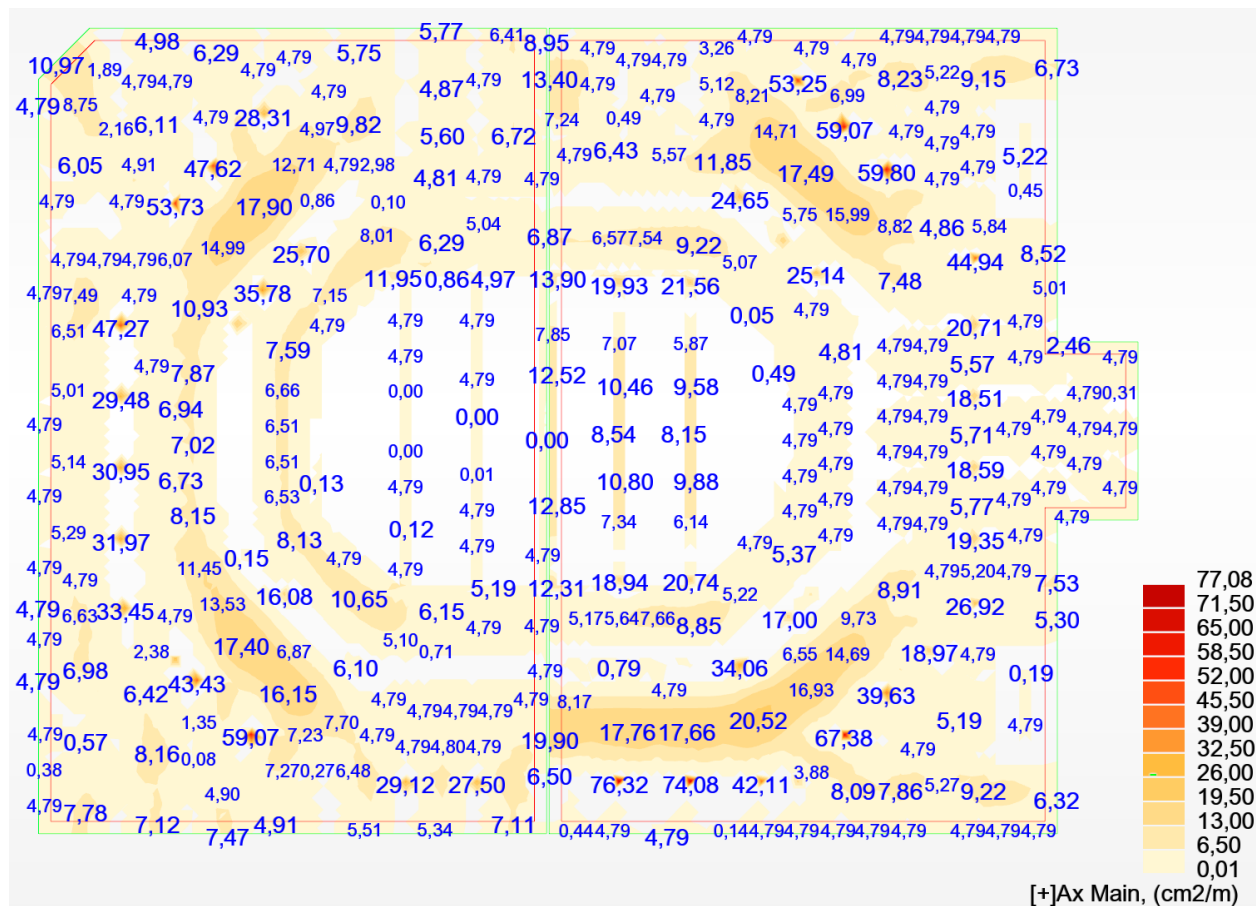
Верхнє армування фунд. плити по напрямку X, см²/м
